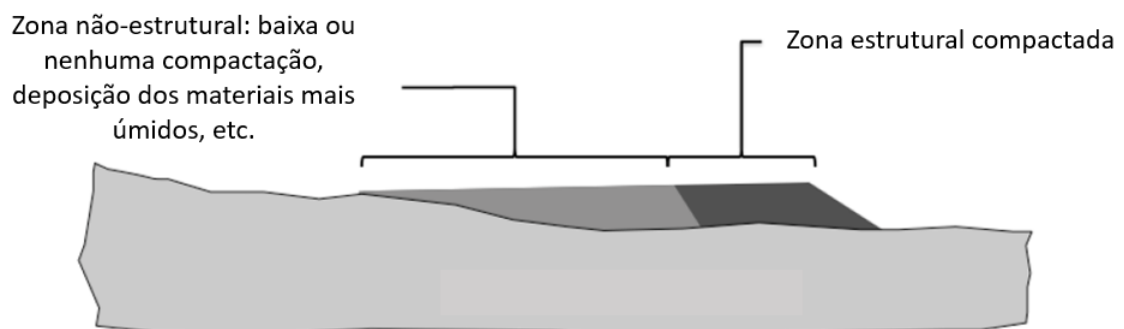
Seção transversal típica de pilha (Lupo e Hall, 2010)
